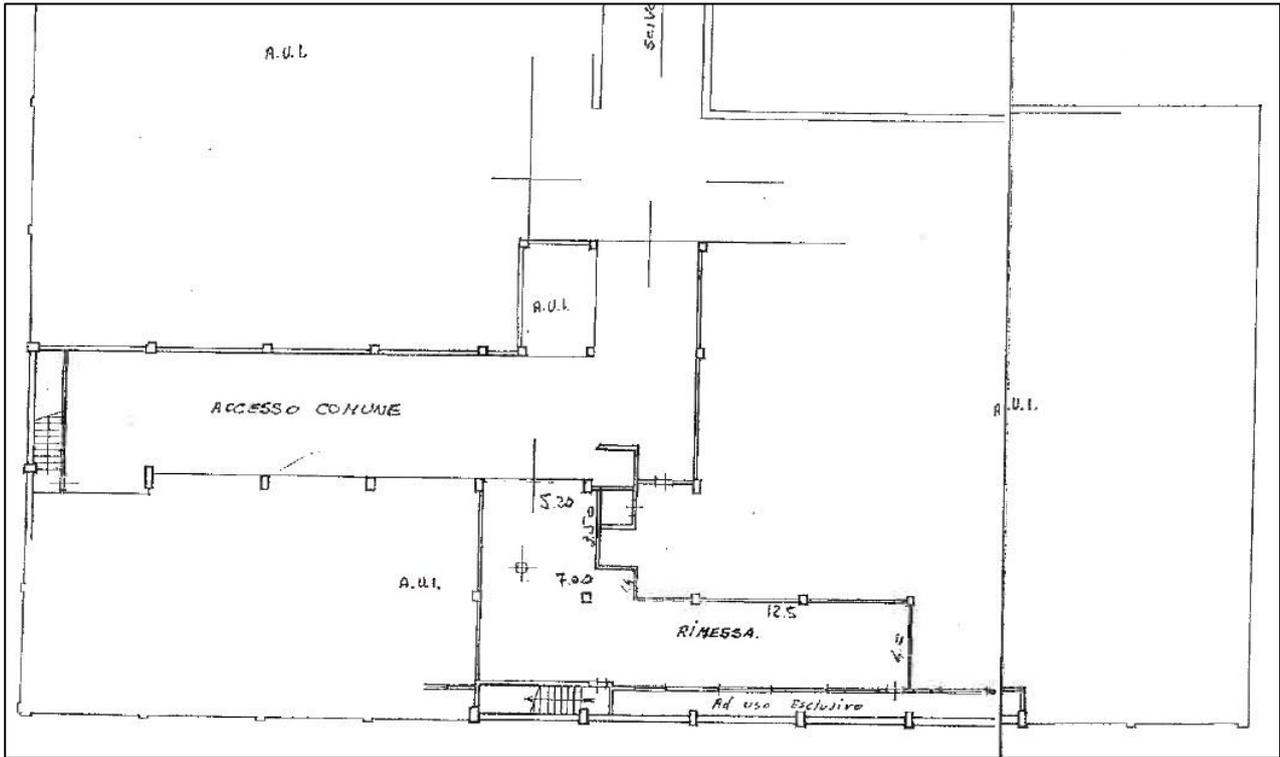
planimetria del piano S1, (sub 29) unità ad uso rimessa
